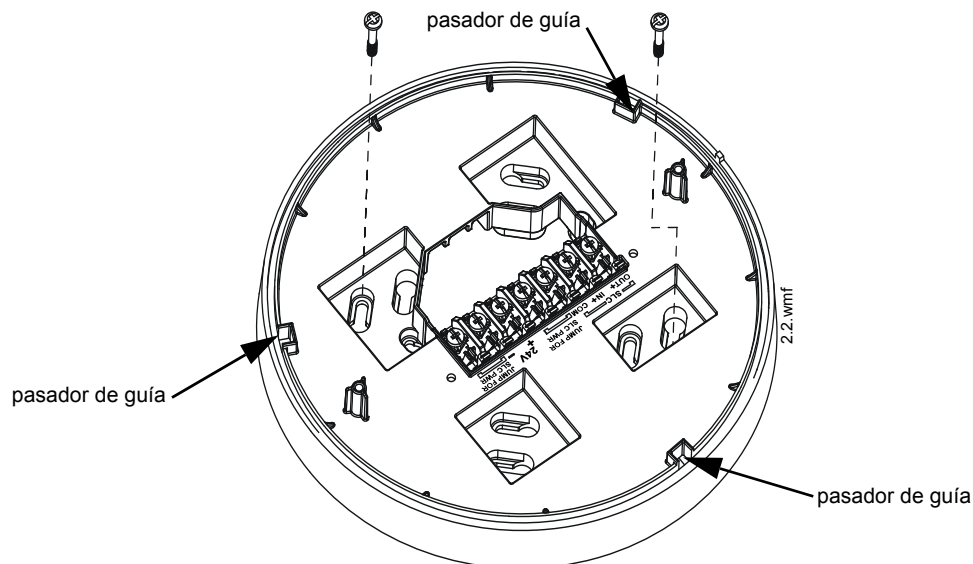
Placa de montaje para el controlador de video inalámbrico
